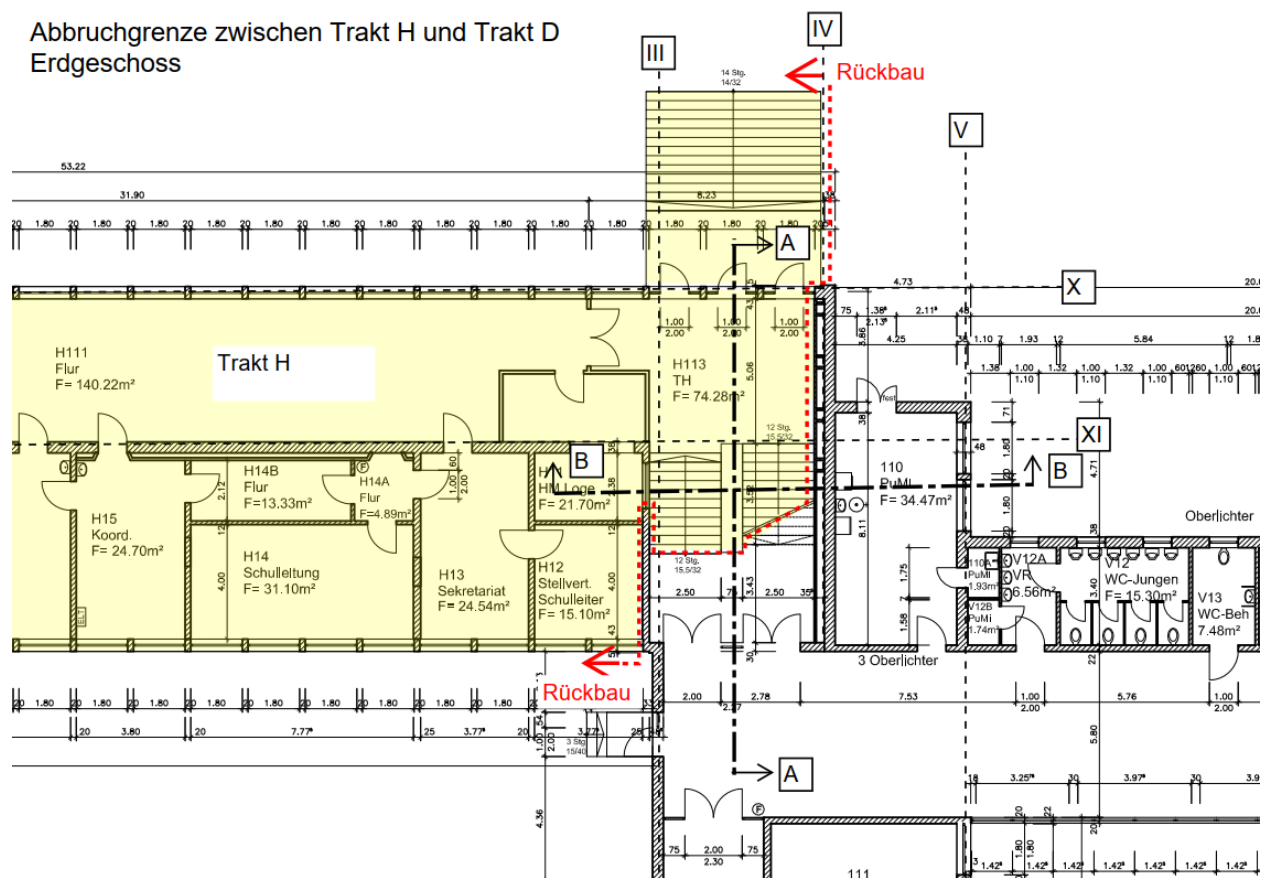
Abbruchgrenze vom Trakt H zum Trakt D – Grundriss Erdgeschoss
